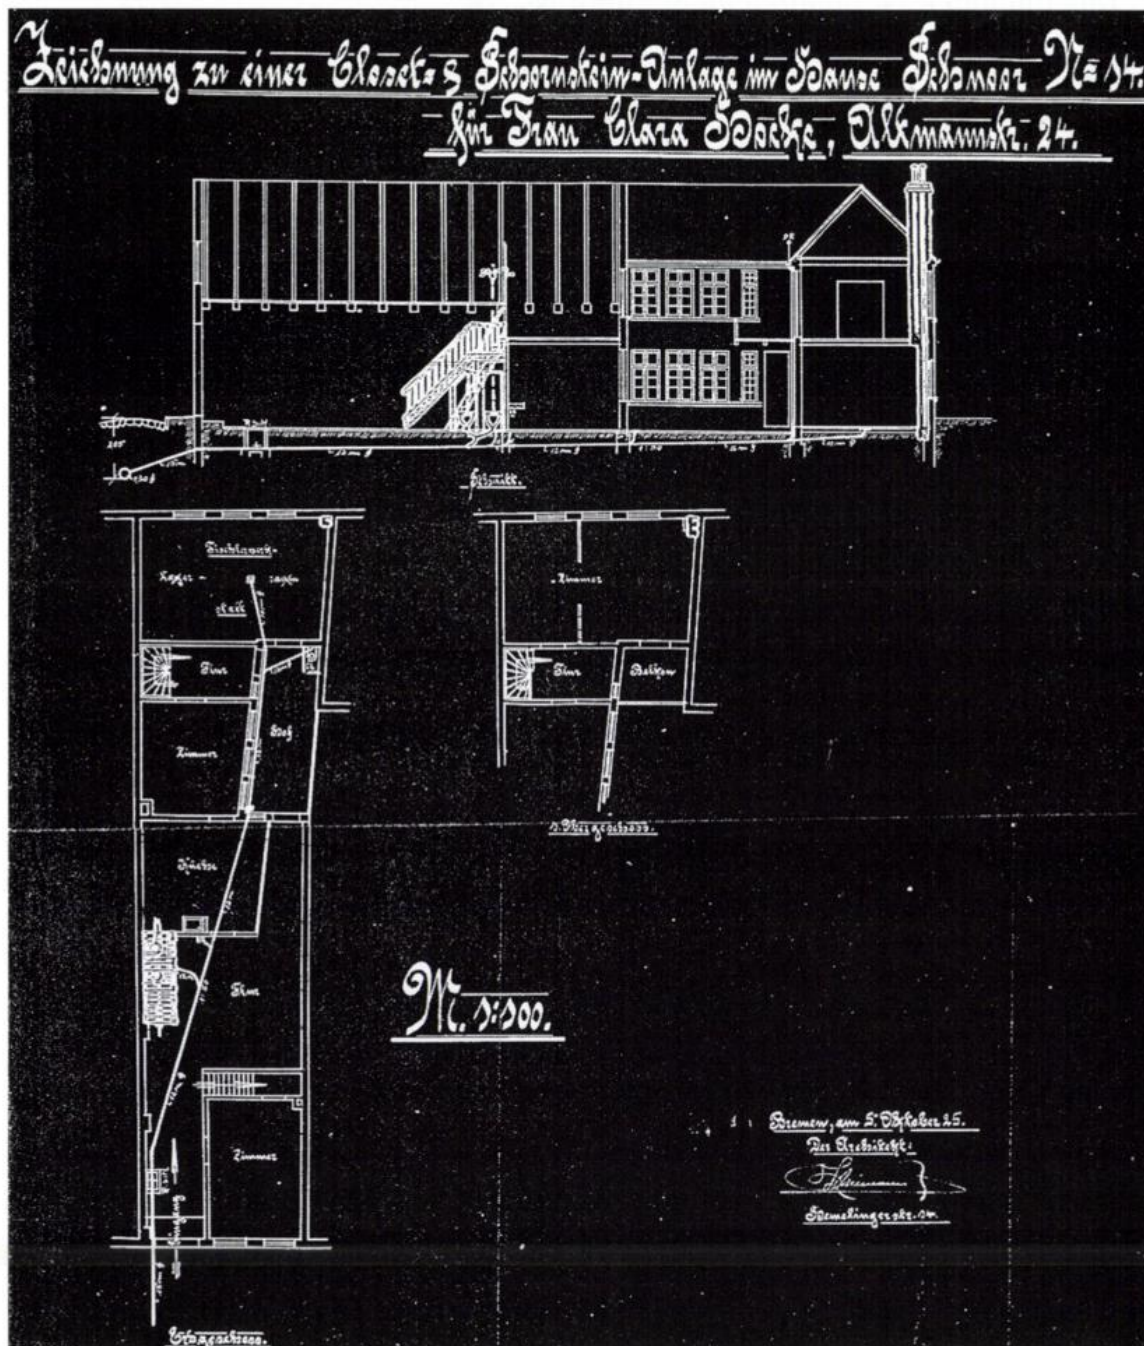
Sielantrag 1925, Längsschnitt durch das Haus. »Zeichnung zu einer Closet- & Schornstein-Anlage im Hause Schnoor Nr. 14«. Bauakten Bauaufsicht, Staatsarchiv Bremen.
